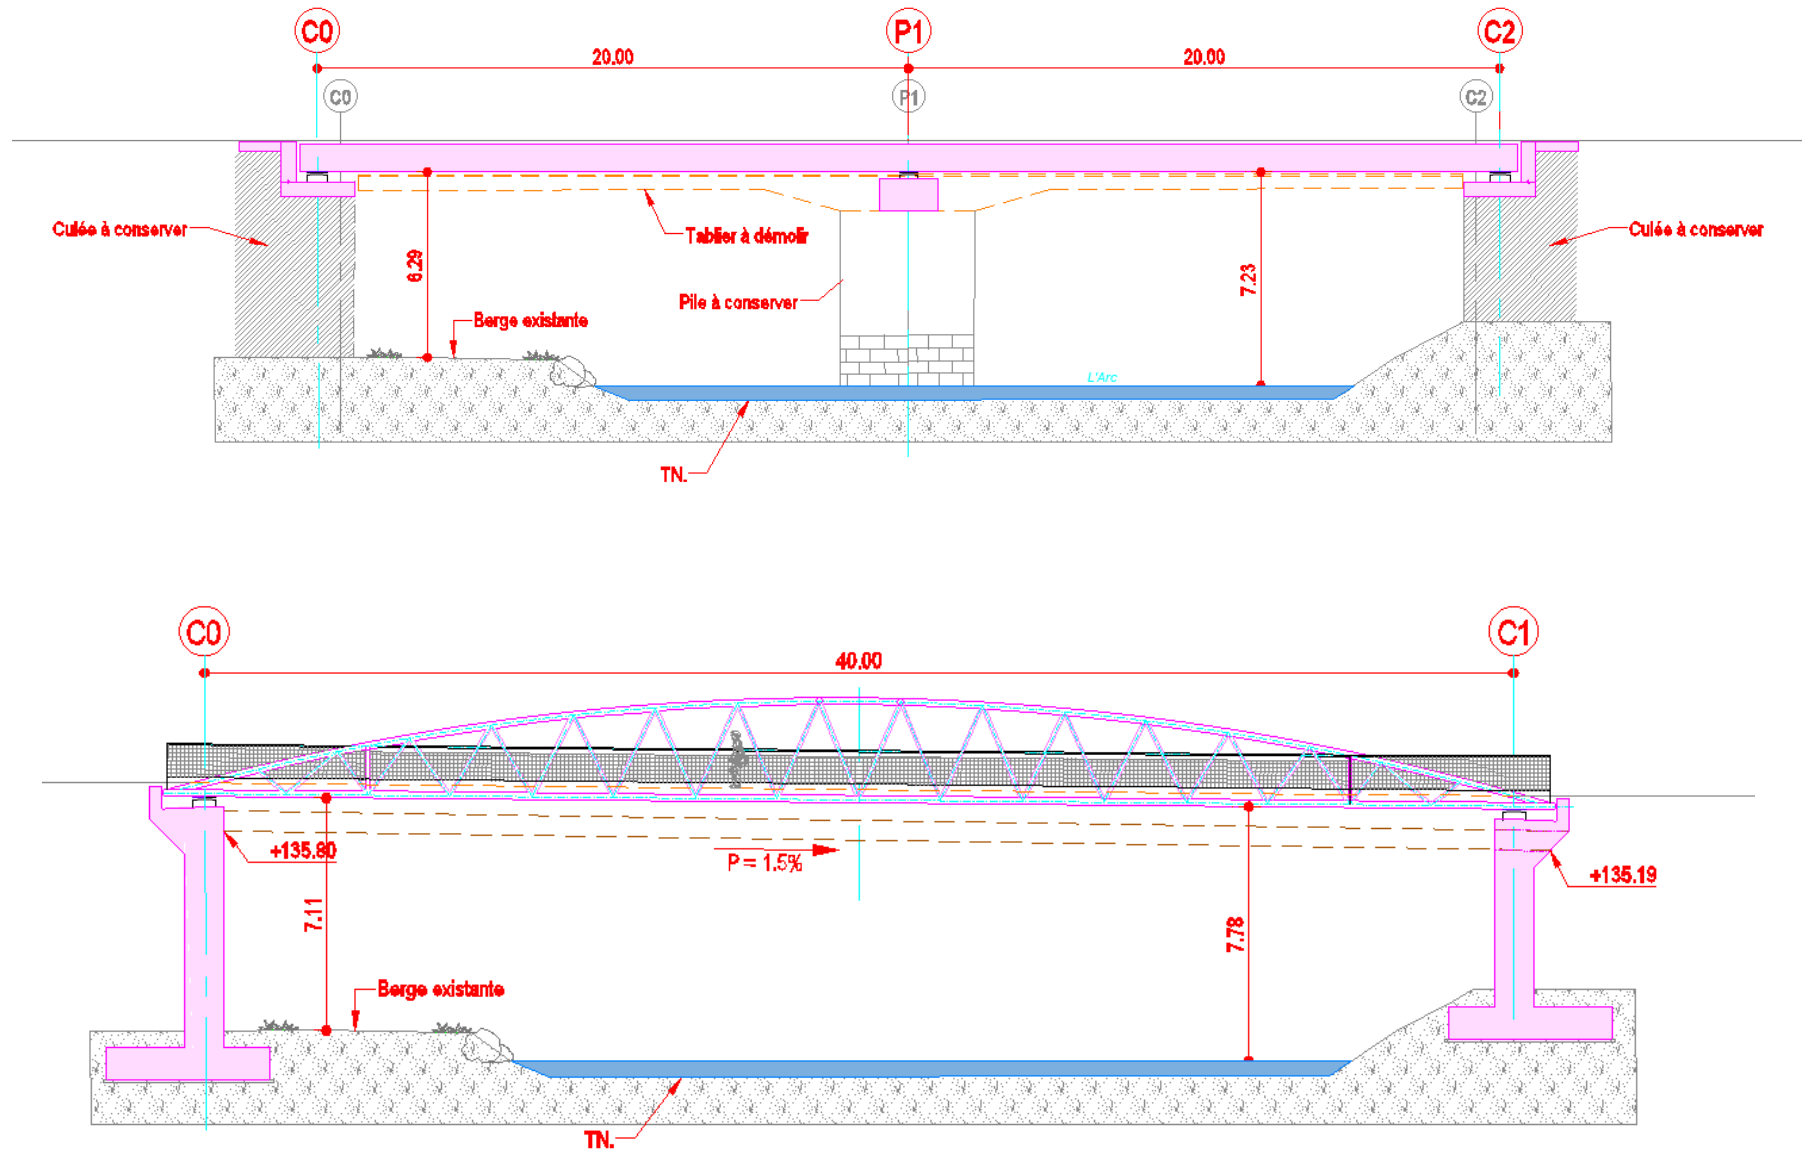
Coupes longitudinales du pont et de la passerelle
